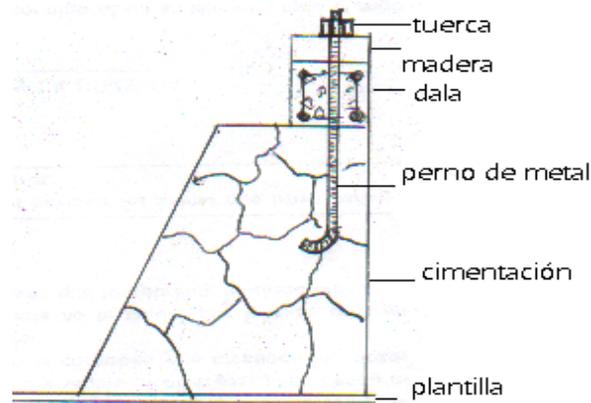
Zapata corrida de mampostería, dala, solera de madera tratada CCA, espárrago ahogado en la cimentación con tuerca y roldana.
